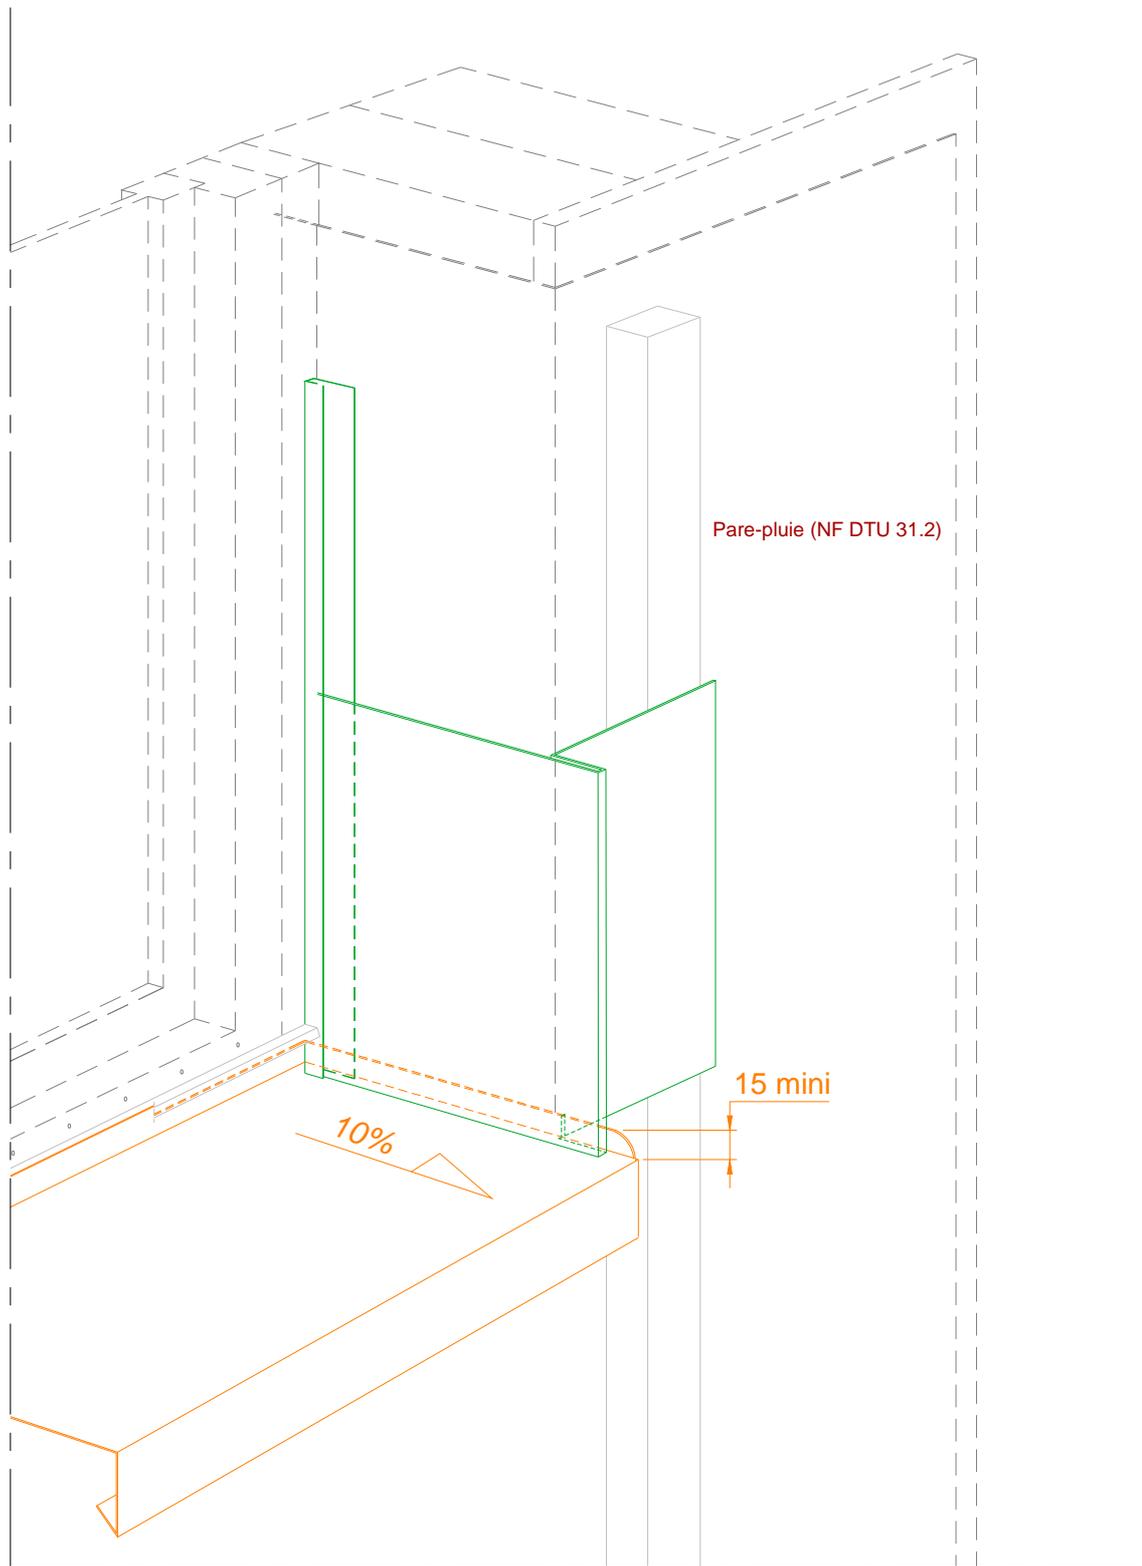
Coupe sur appui de baie - Pose sur COB,
